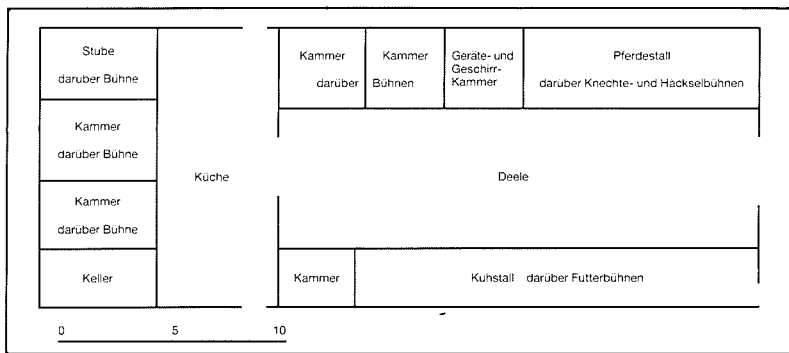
Grundrißmodell der älteren Bauernhäuser des Kreises Paderborn (Niederdeutsches Hallenhaus)
